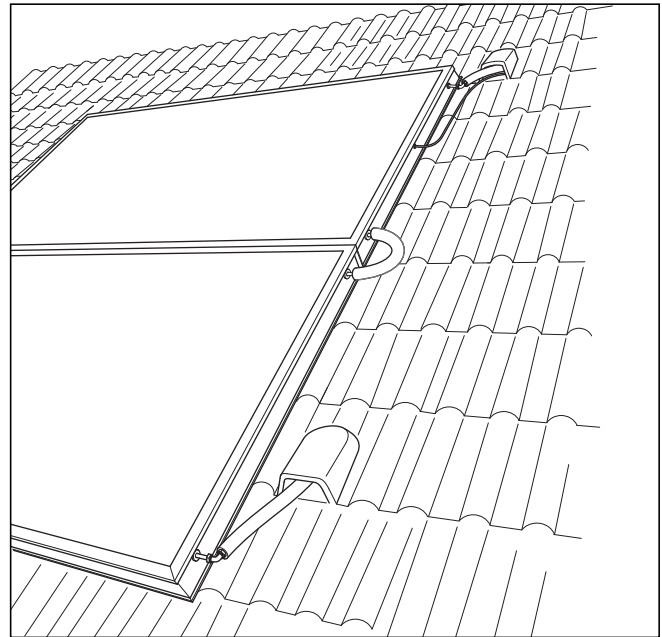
capteurs plans auroTHERM en montage sur toiture
